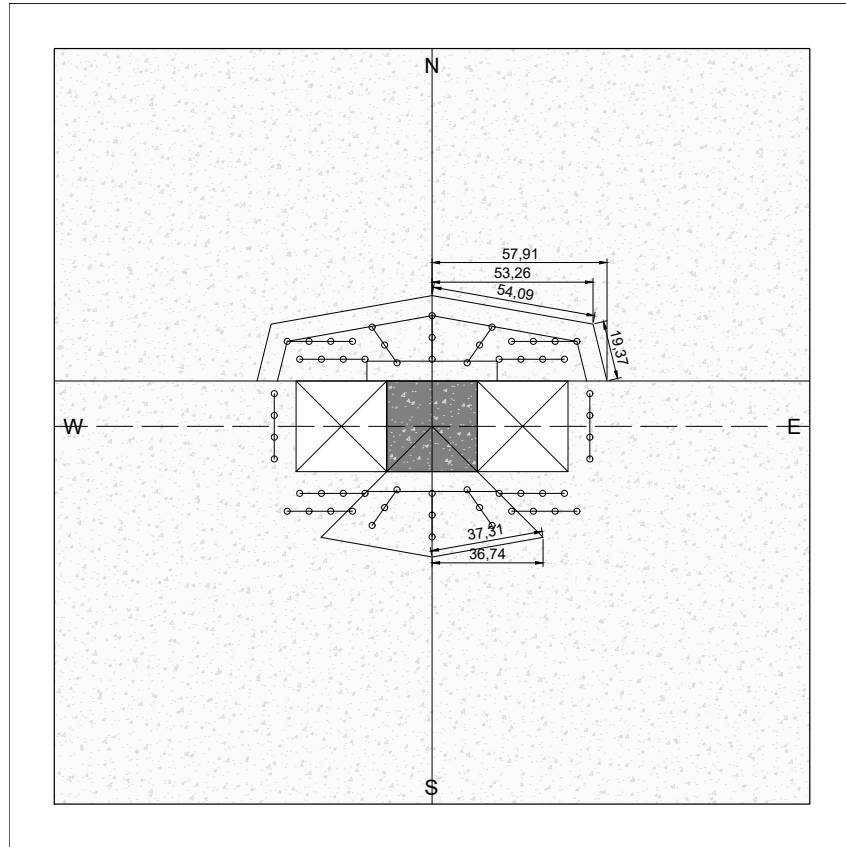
Perímetros externos segundo ACI 318-19 da laje LFS2
